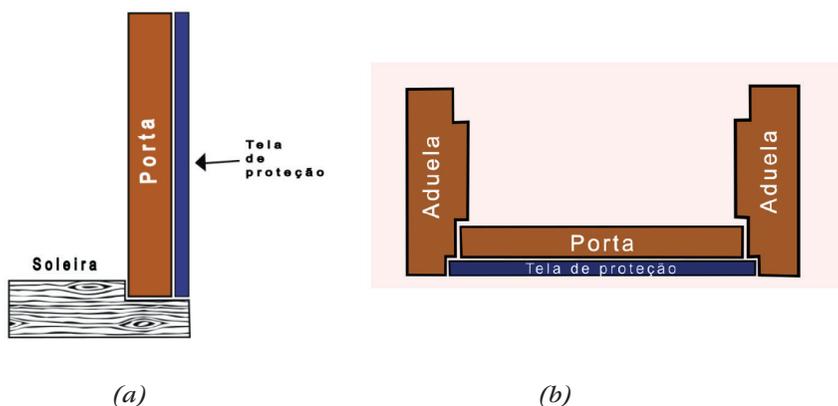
Proteção de soleiras em portas: a) Vista lateral da porta e pormenor do remate entre soleira e porta; b) Vista em planta da porta e pormenor do remate entre as aduelas e porta.
